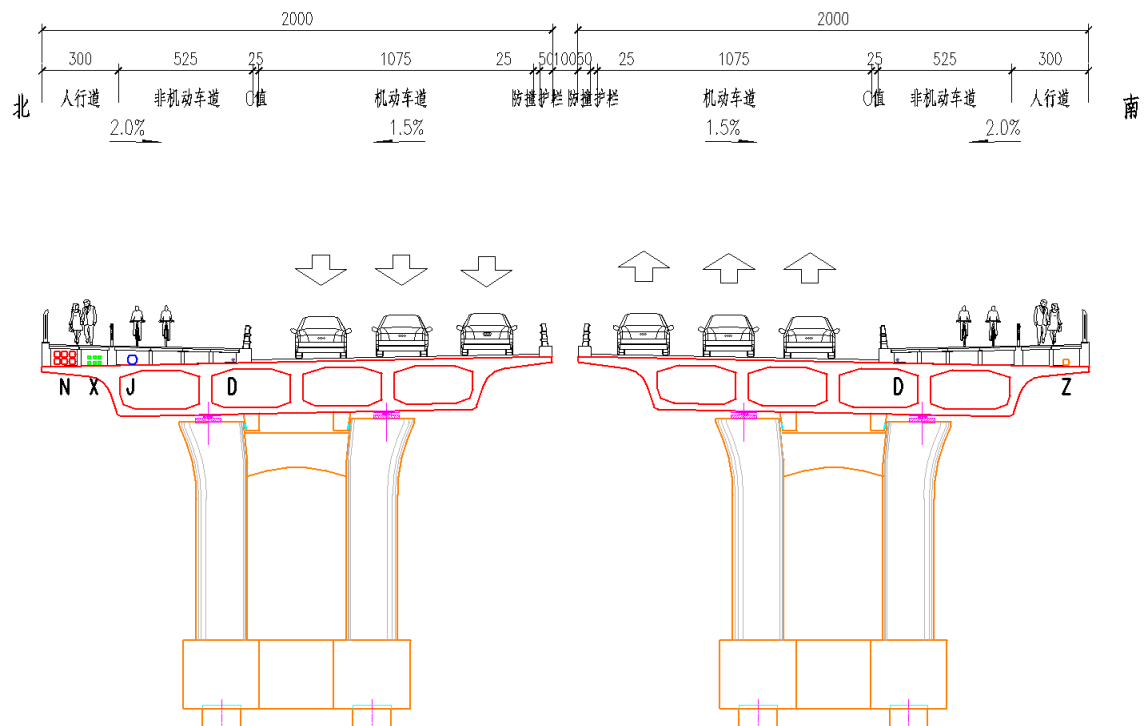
浯江道 2 号桥管位标准横断面布置图
